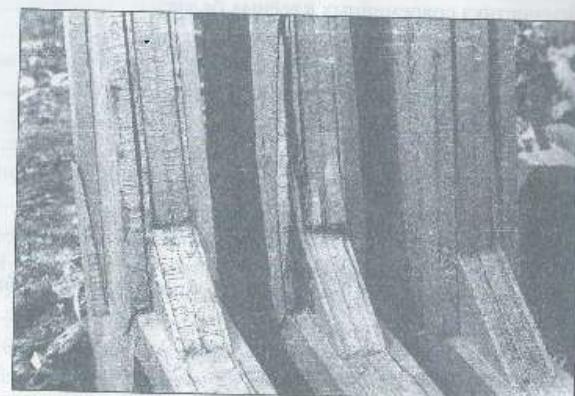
Разрушение жестких узлов клееных рам с вутами
